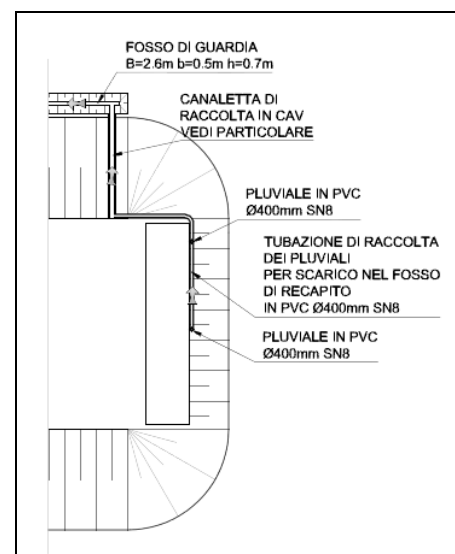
schema planimetrico dello scarico delle acque di piattaforma dal ponte del T. Crostolo
